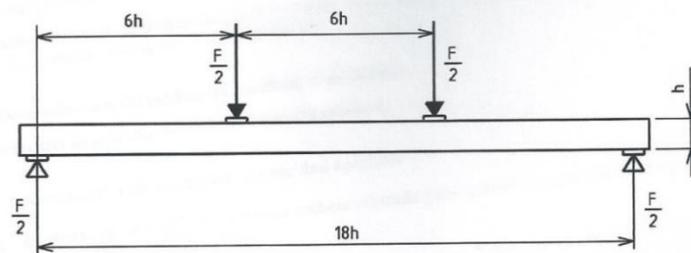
DETALLE ACOTADO DEL ENSAYO.
